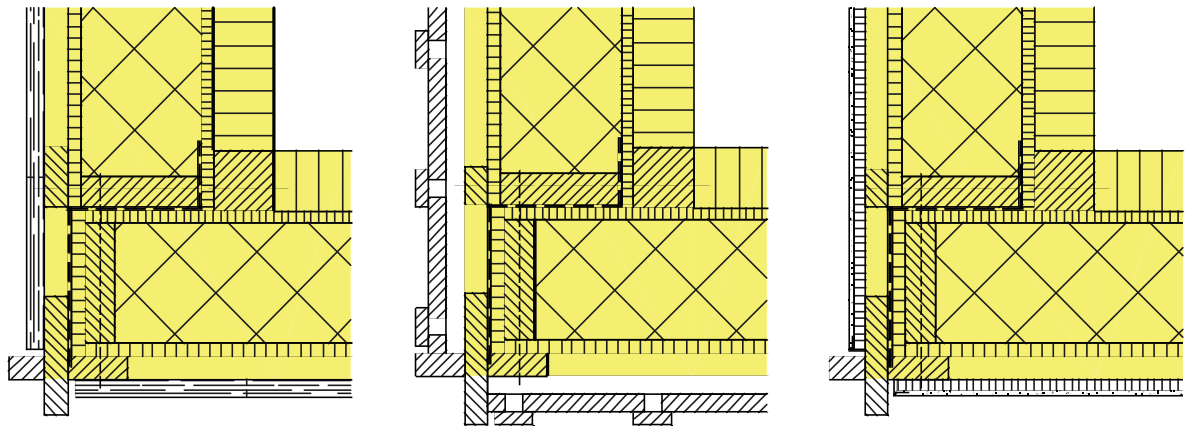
Details Gebäudeecke, hor./vert. Schalung, Putz, M 1:10
